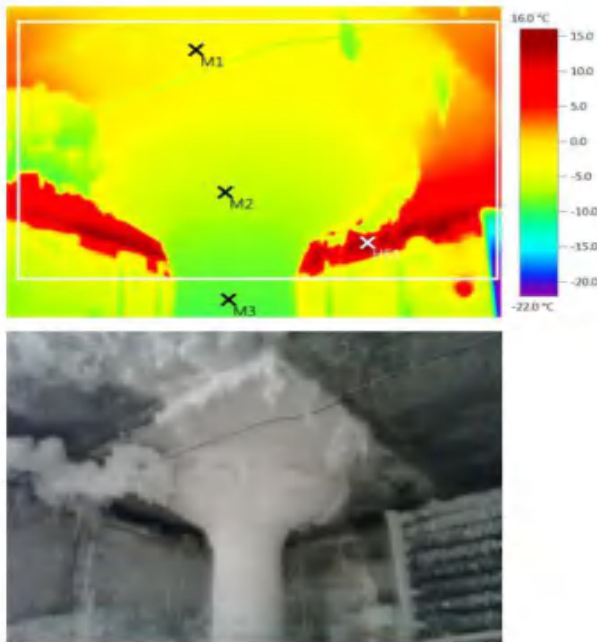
Термическое изображение участка колонны и покрытия в помещении холодильной камеры / Thermal image of the column and roof slab
